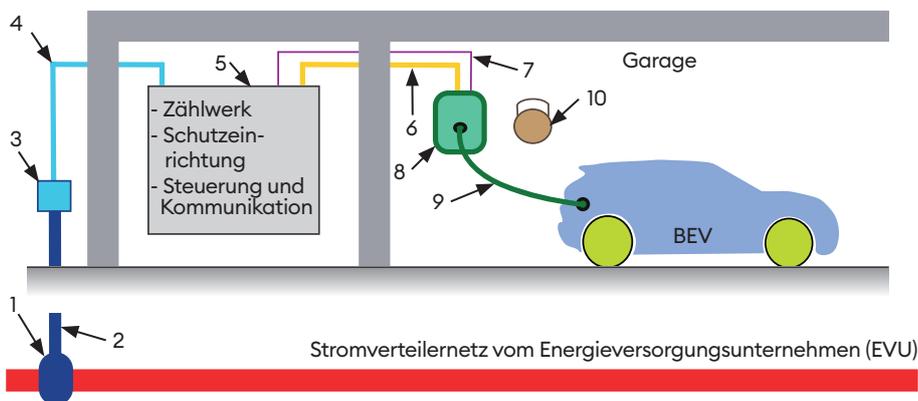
Prinzipdarstellung der Elektroinstallation mit Ladeeinrichtung
